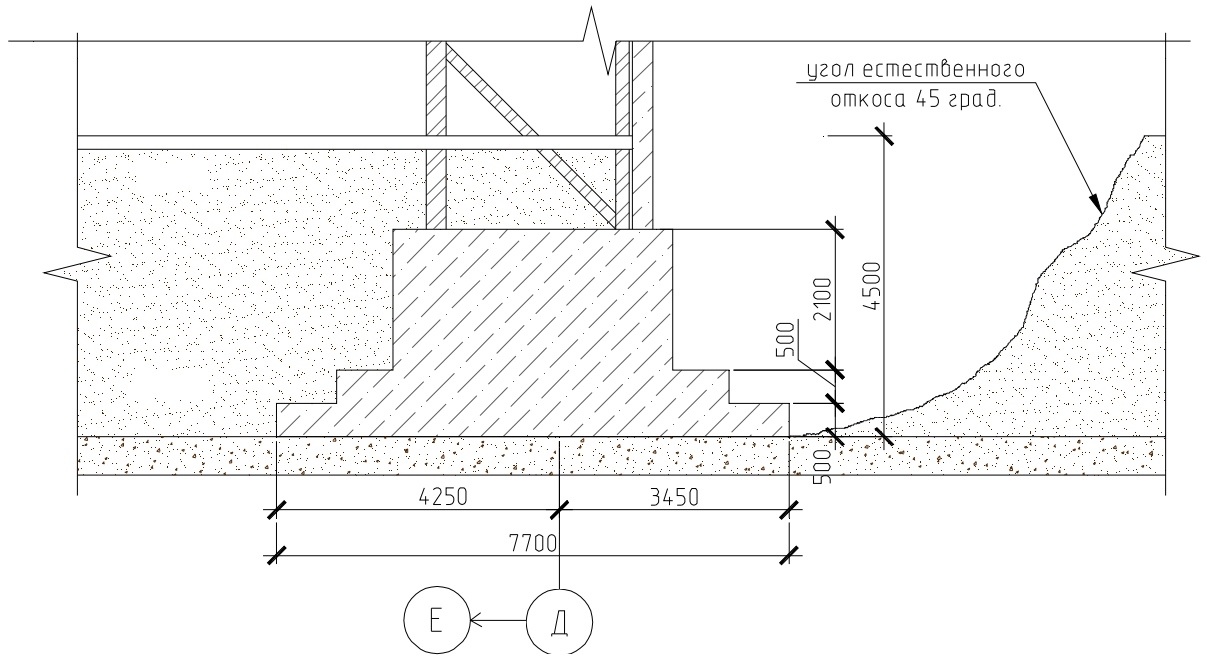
Схема фундамента в осях «15/Д»
